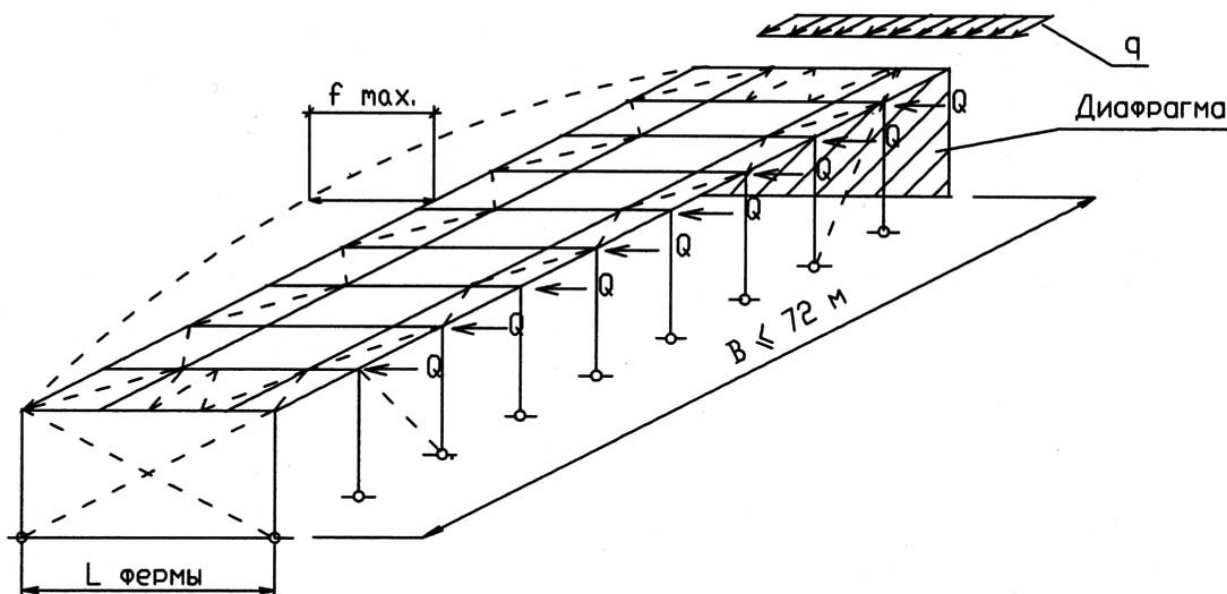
Пространственная расчетная схема каркаса при ветровой нагрузке.
